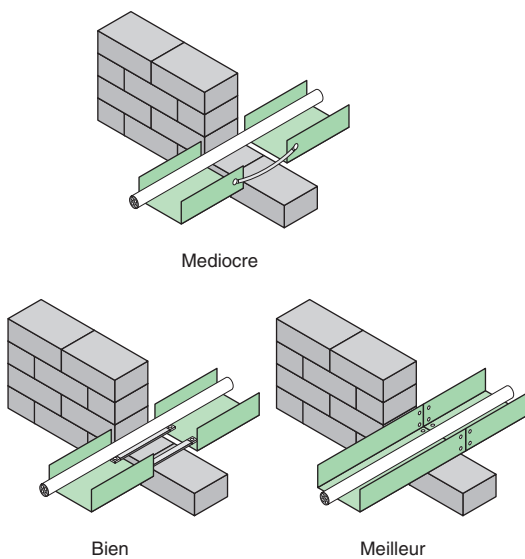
Recommandations pour une traversée de mur par un conduit métallique
